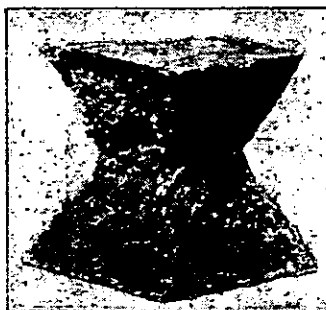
Probeta cúbica de hormigón para ensayo de compresión.
